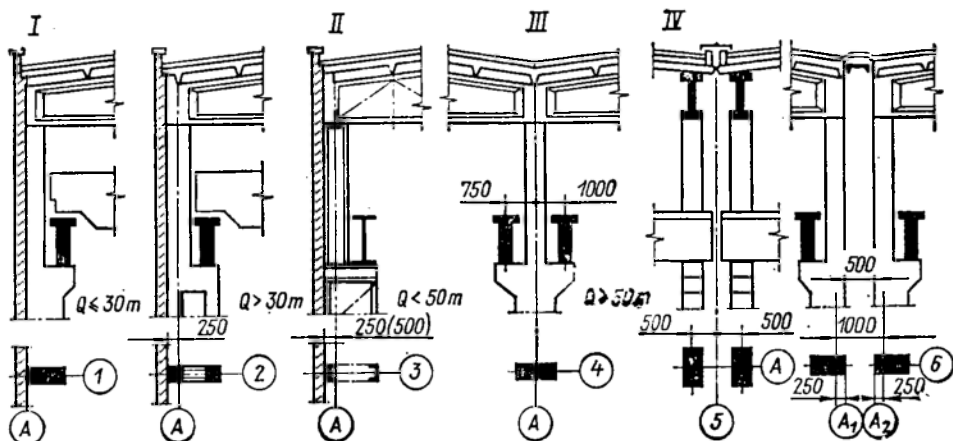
Привязка элементов зданий к разбивочным осям зданий, оборудованных кранами: I — железобетонные колонны с шагом 6 и 12 м; II — стальные колонны; III — средние ряды колонн; IV — температурные швы; продольные оси показаны буквами, поперечные оси (ряды) — цифрами
